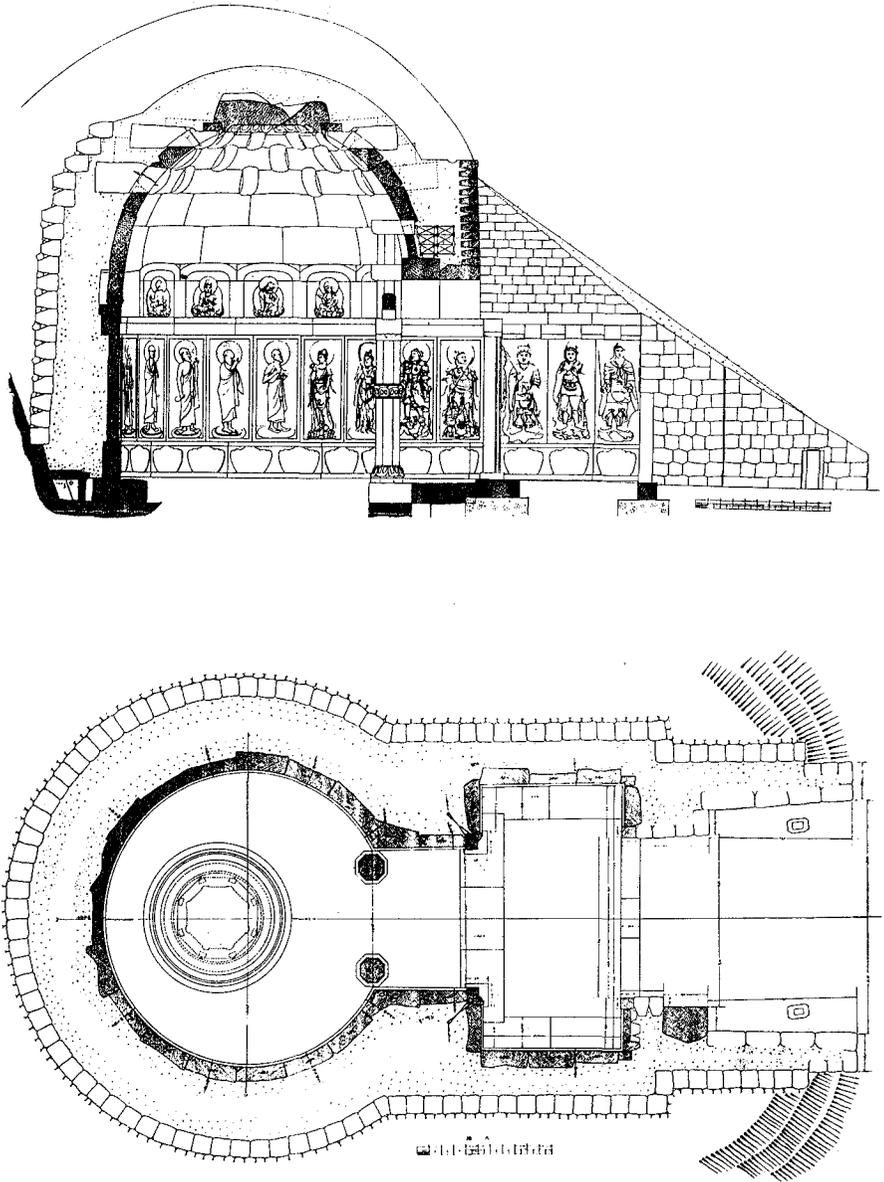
Planta y sección de Sokkuram. Kyongju.
